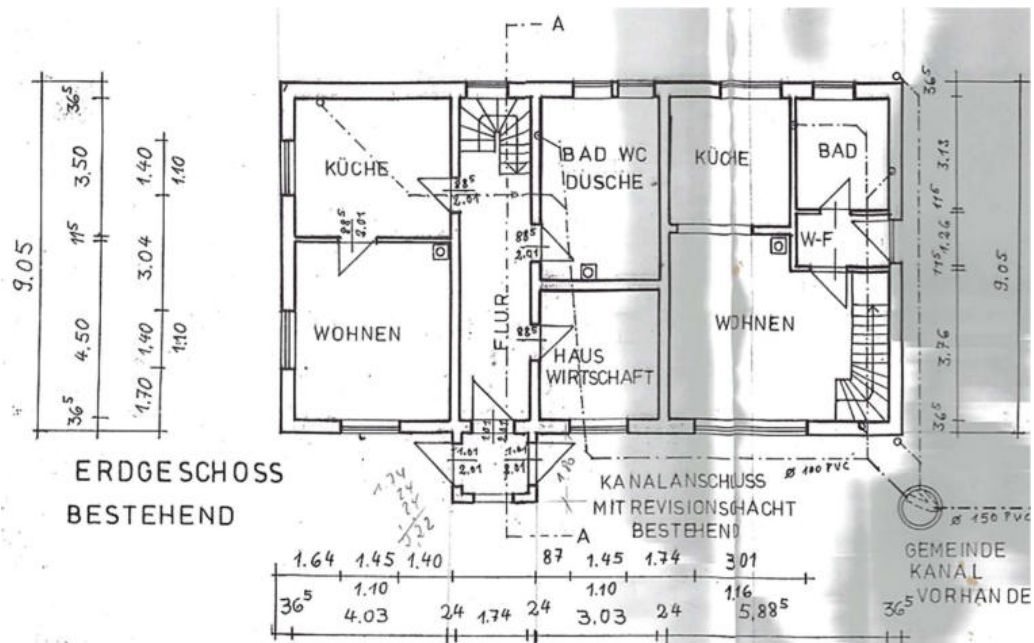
Grundriss Erdgeschoss (Aufstockung 1997)
